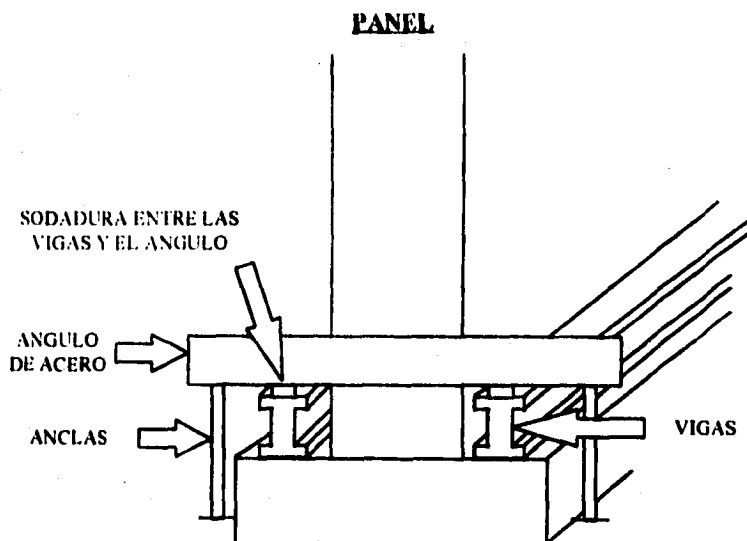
Detalle de las vigas de acero soldadas a los ángulos.
